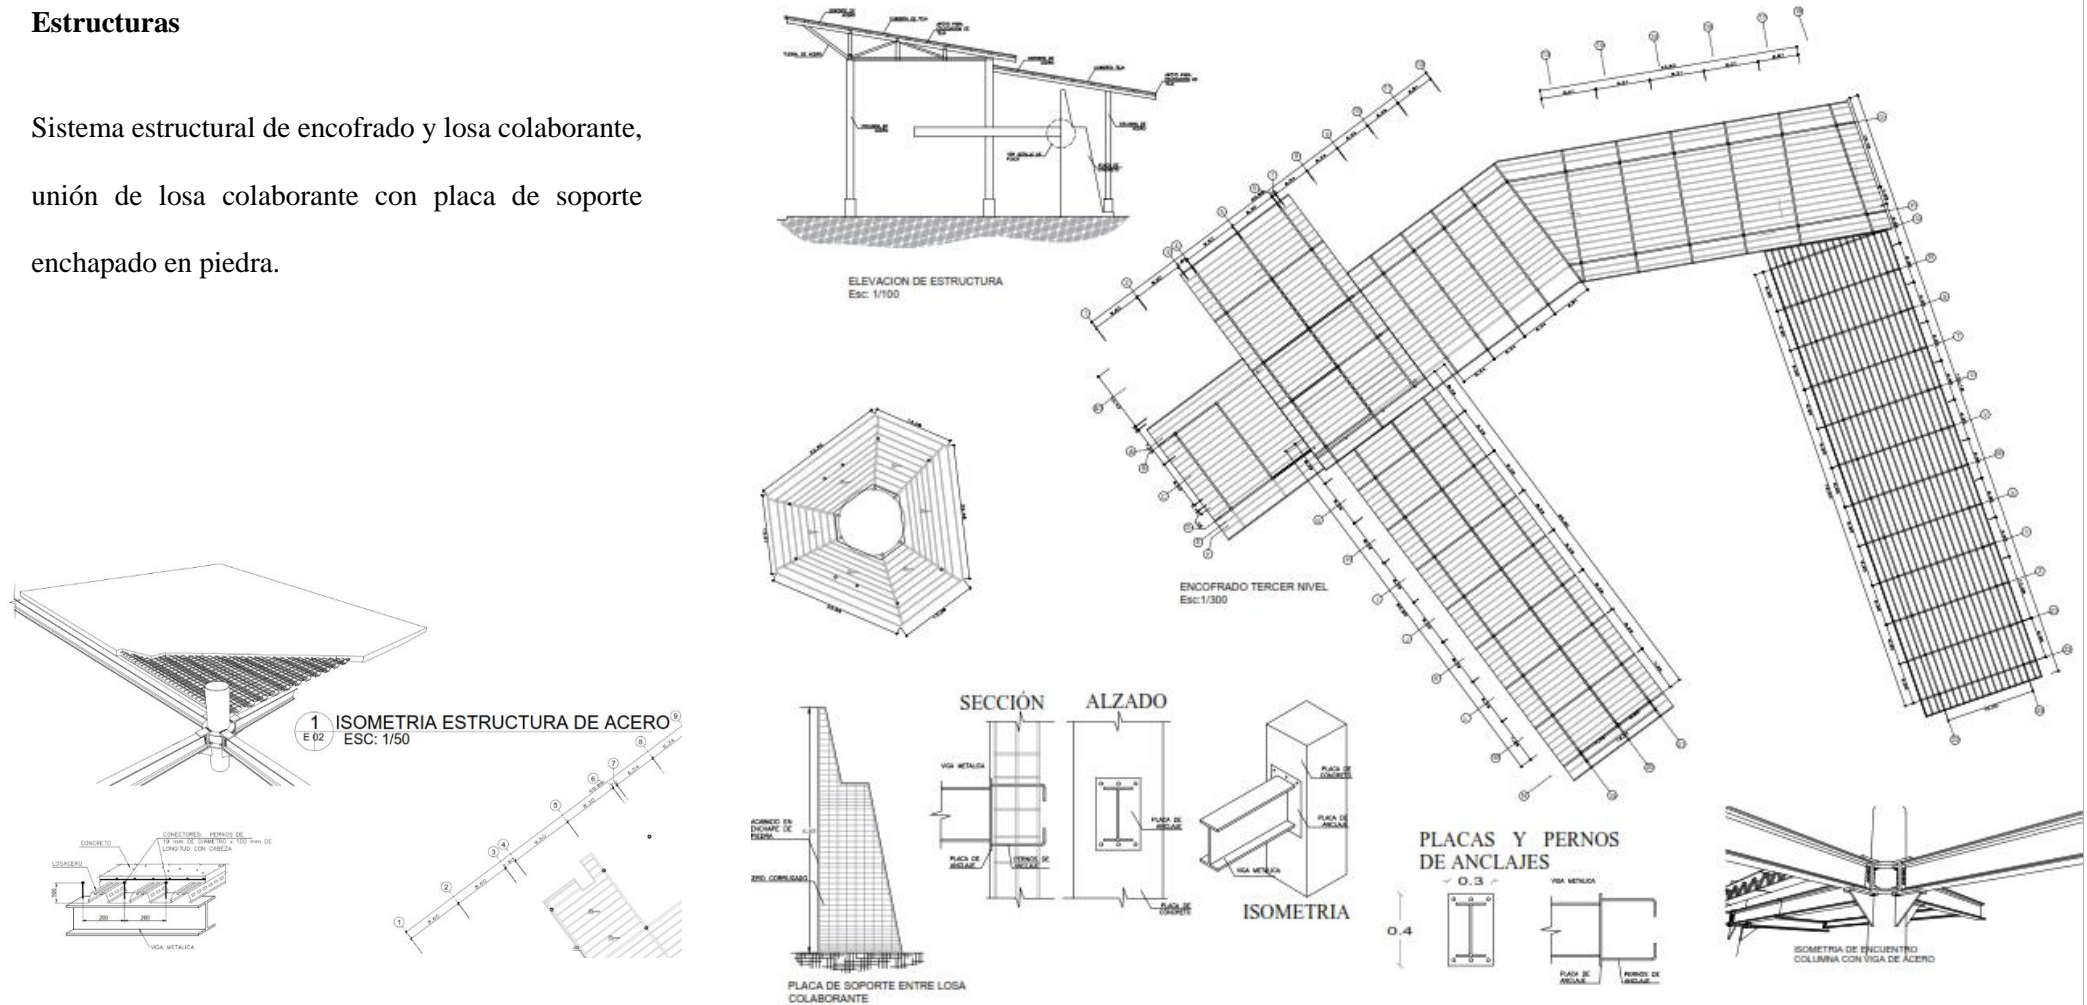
Plano de encofrado de techos de todo el proyecto. Autoría propia.
